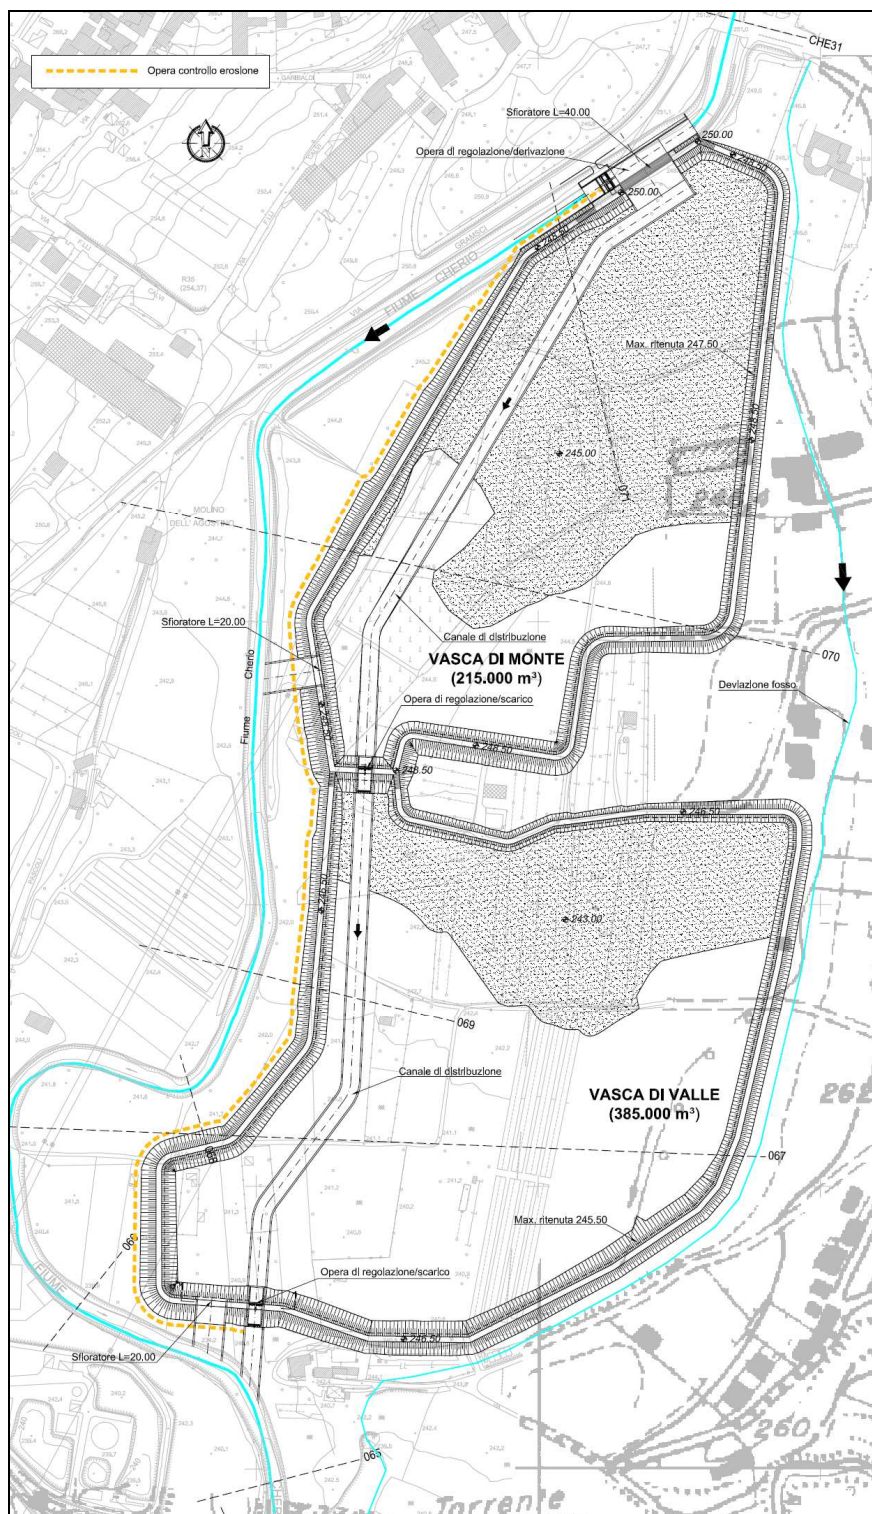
Planimetria di progetto delle aree di laminazione di Molino dei Frati (Fonte: Studio-AdBPo)
